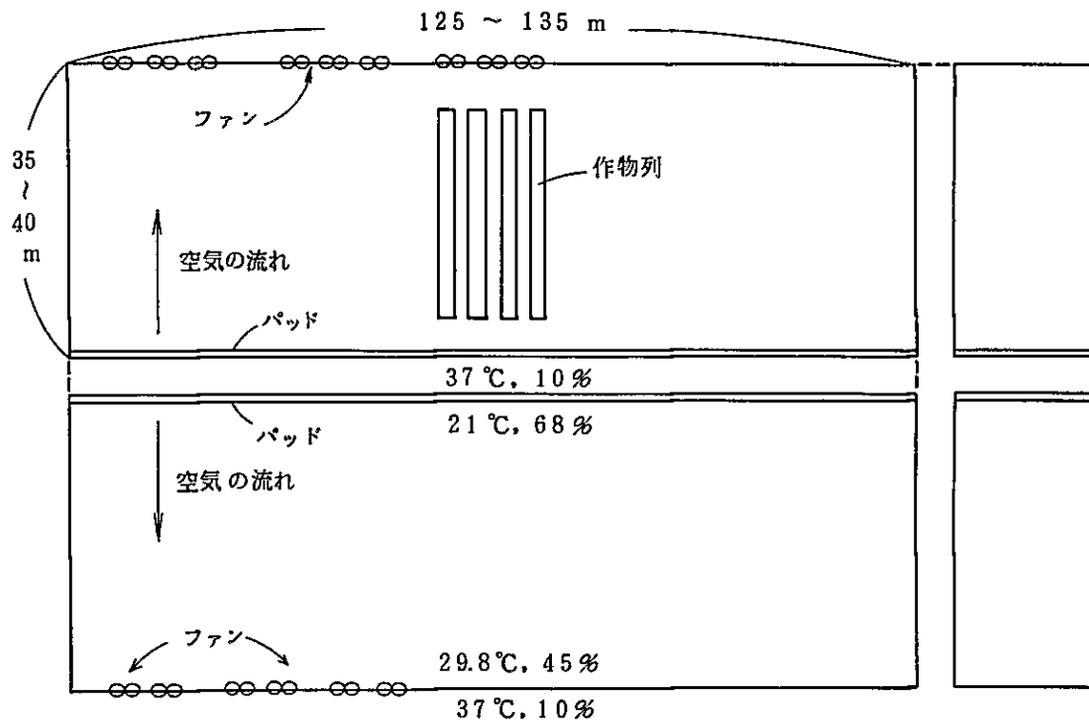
温室平面図 (測定値は Al Owaida 農場にて)
